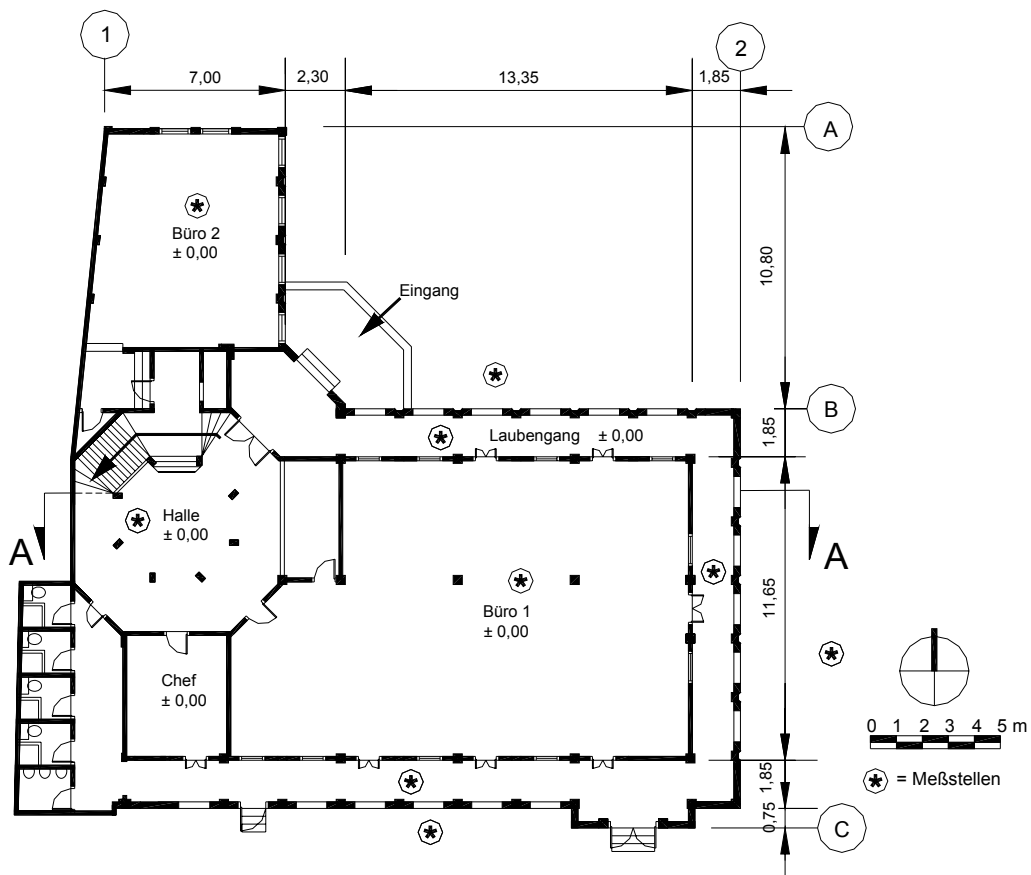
Grundriss Erdgeschoss von Gebäude C5
